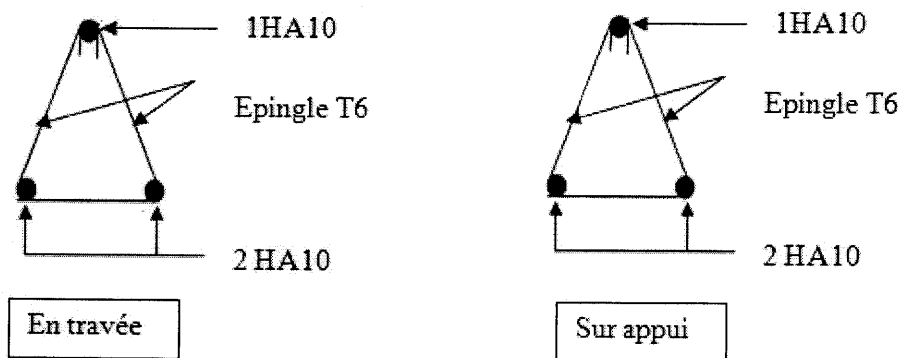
Schéma de ferrillages des poutrelles (planchers terrasse+étage courant).
